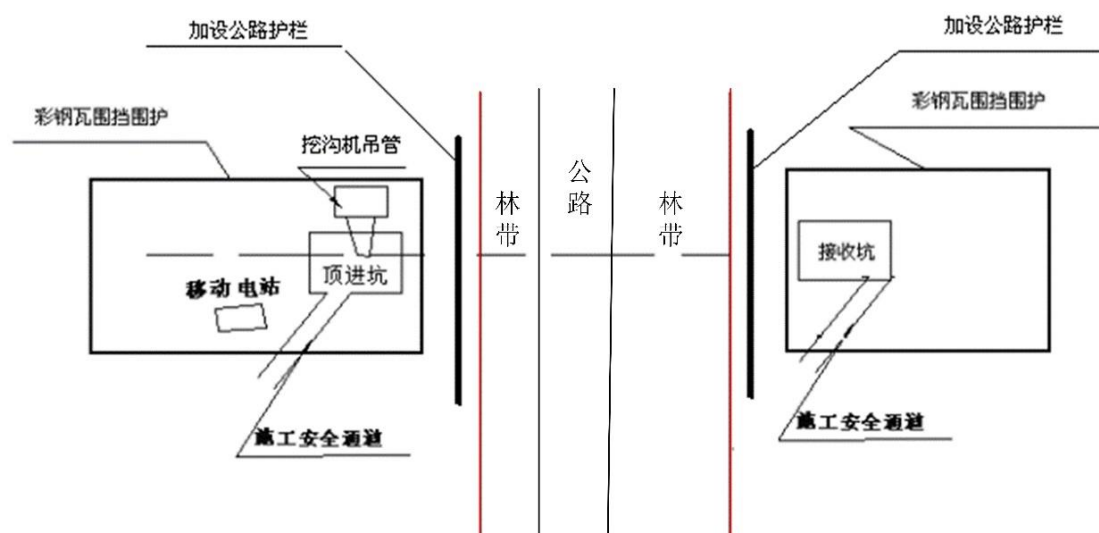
沿海防护林带生态保护红线施工场地布置示意图
